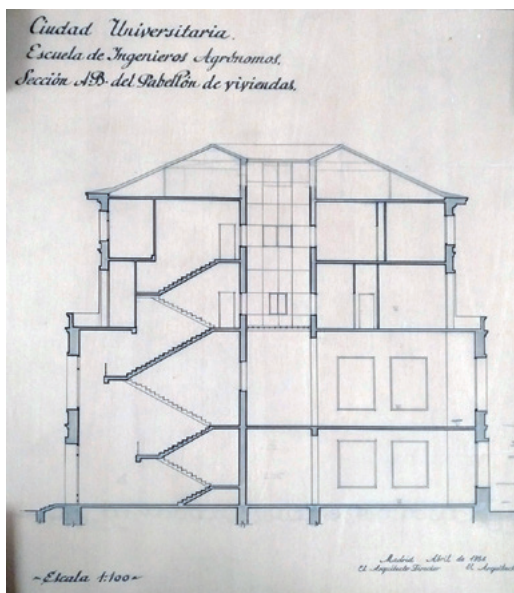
Proyecto de ampliación y reforma... Javier Barroso, 1954. Sección del pabellón de viviendas. Fuente: AGUCM, 179-16-22.
